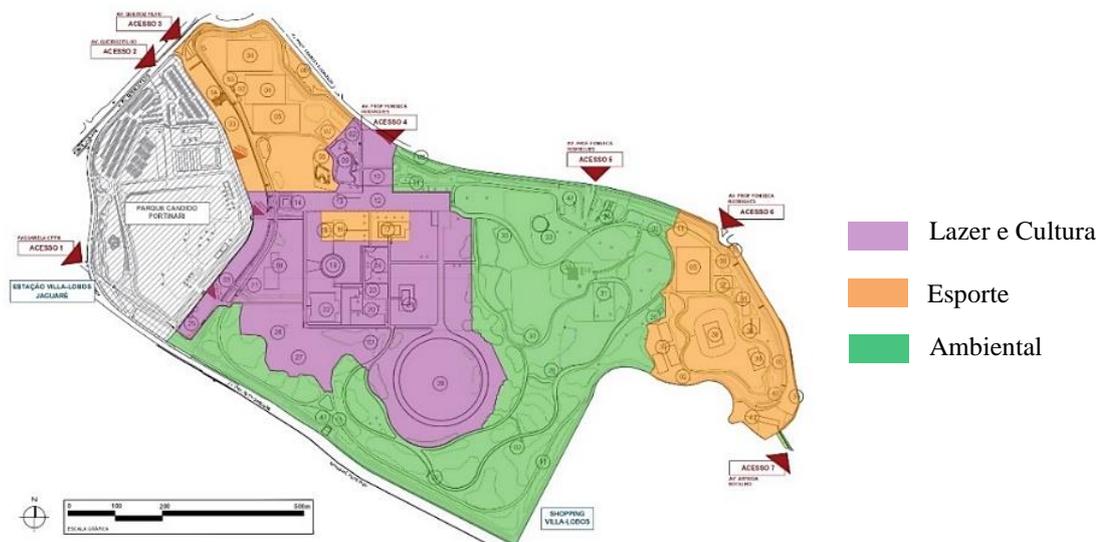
Planta de implantação geral Parque Villa-Lobos.
